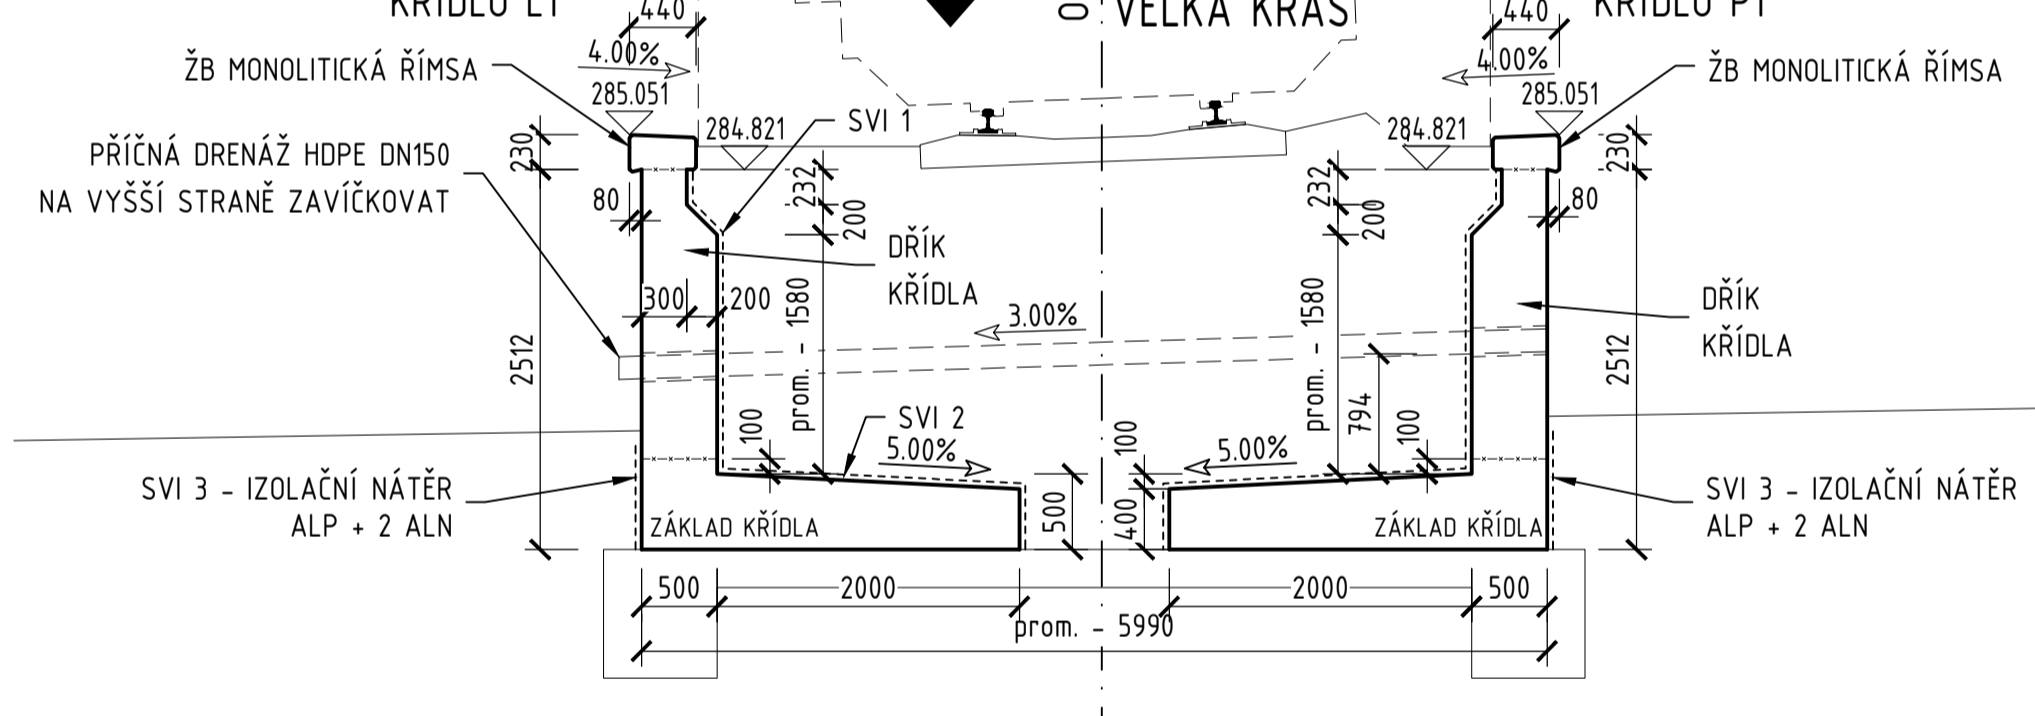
DETAIL PROSTUPU DRENÁŽE KŘÍDLEM 1:10
